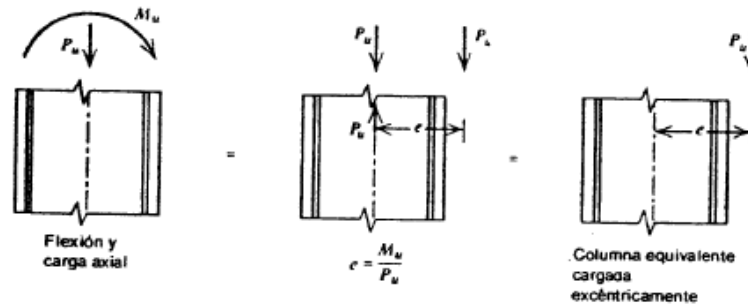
Columnas a flexocompresión (Park y Paulay, 1988)
